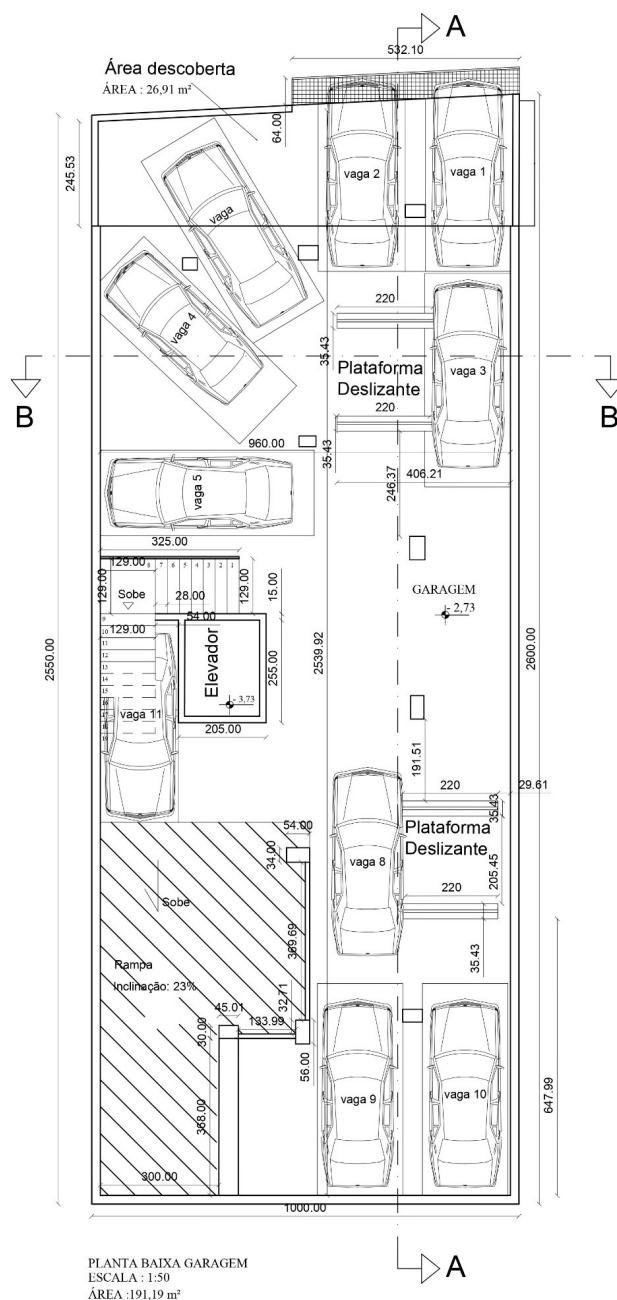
Imagem da garagem onde foi realizado o levantamento
